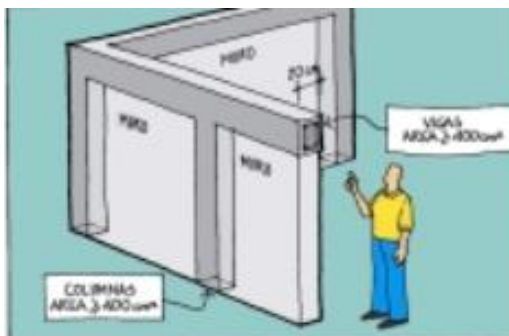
Detalles columna y viga V. Baja (AIS, 2001)
